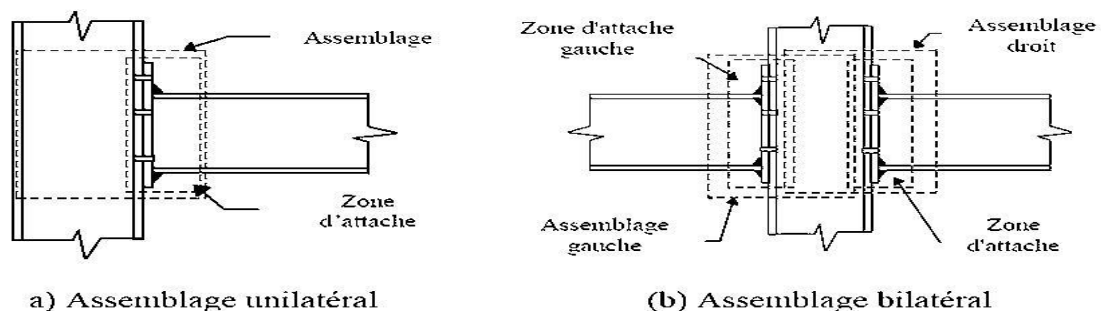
Définition de la zone d'attache et de l'assemblage (assemblage poteau-poutre)
